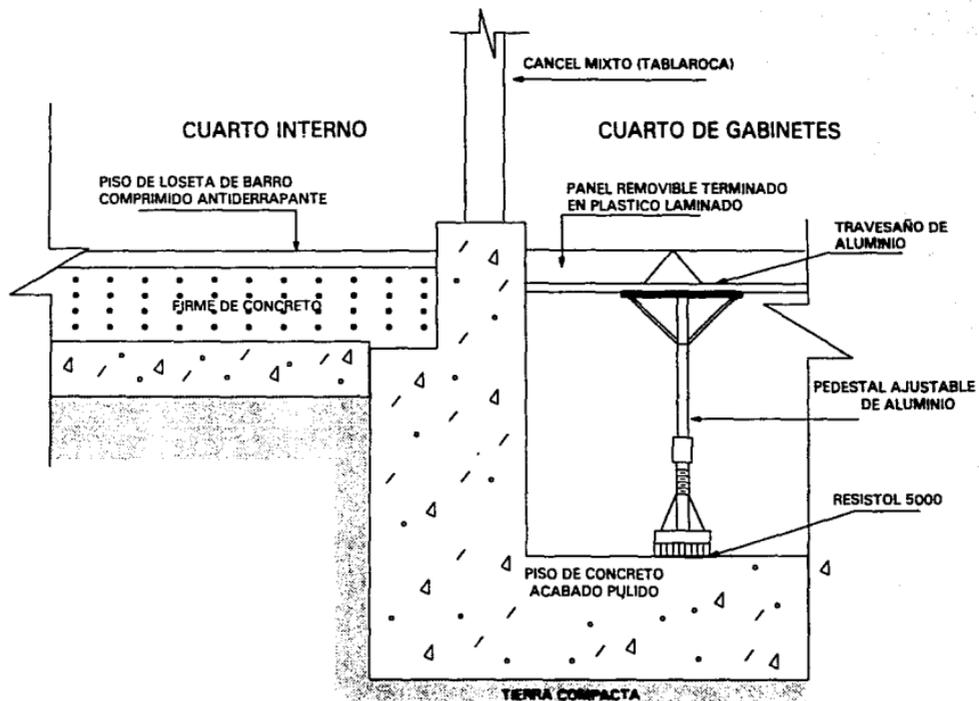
DETALLE CONSTRUCCION DEL PISO FALSO
